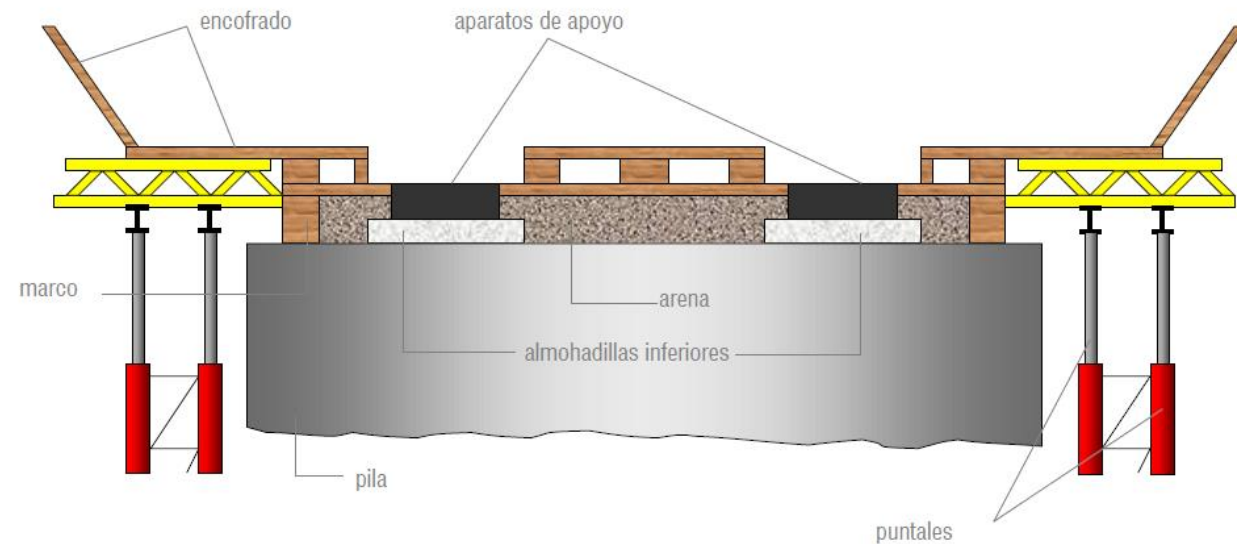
Detalles de puesta en obra de los aparatos de apoyo, método de la caja de arena para tablero hormigonado in situ.
